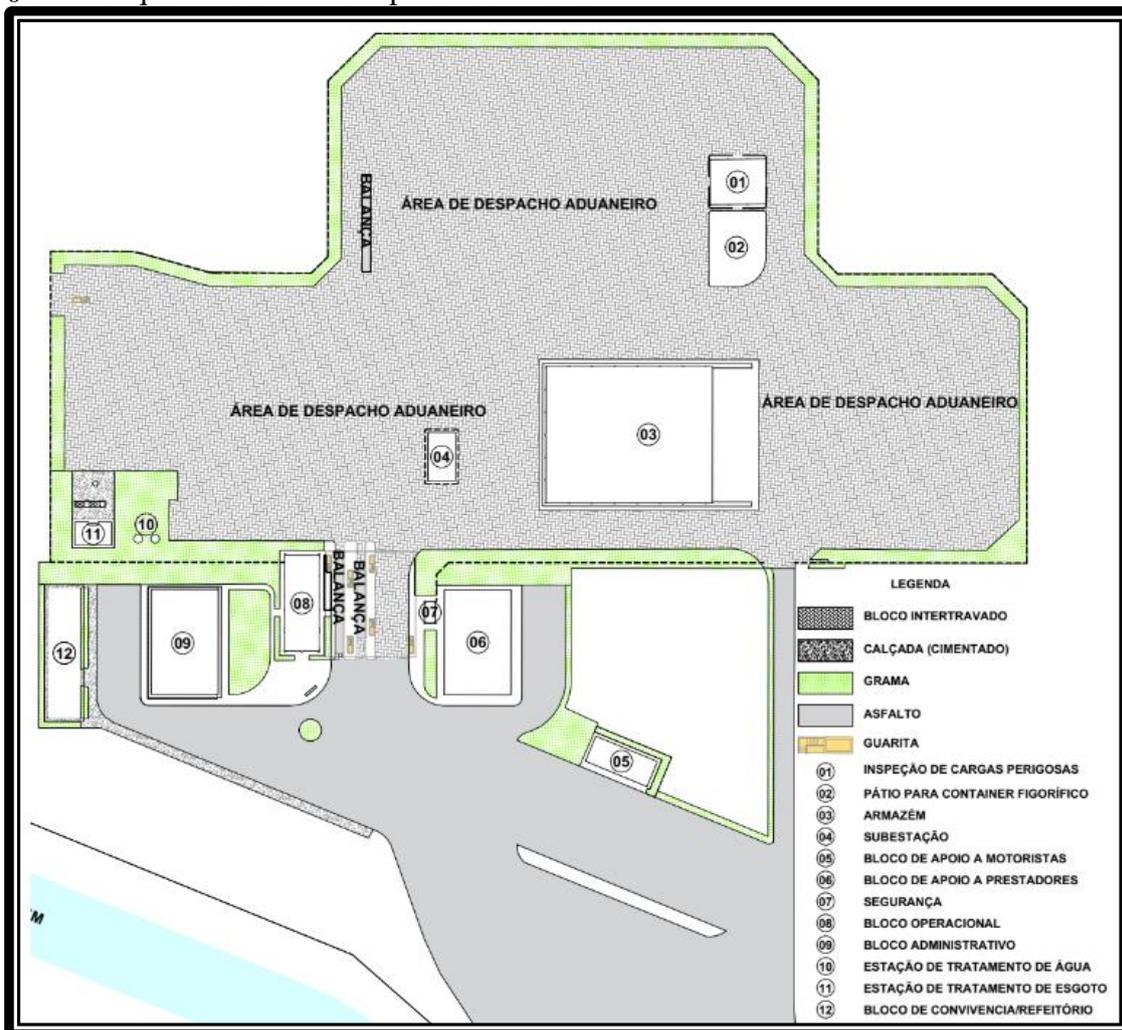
Planta ZPE CEARÁ 01-ADA-SITU-001-Rev 01
